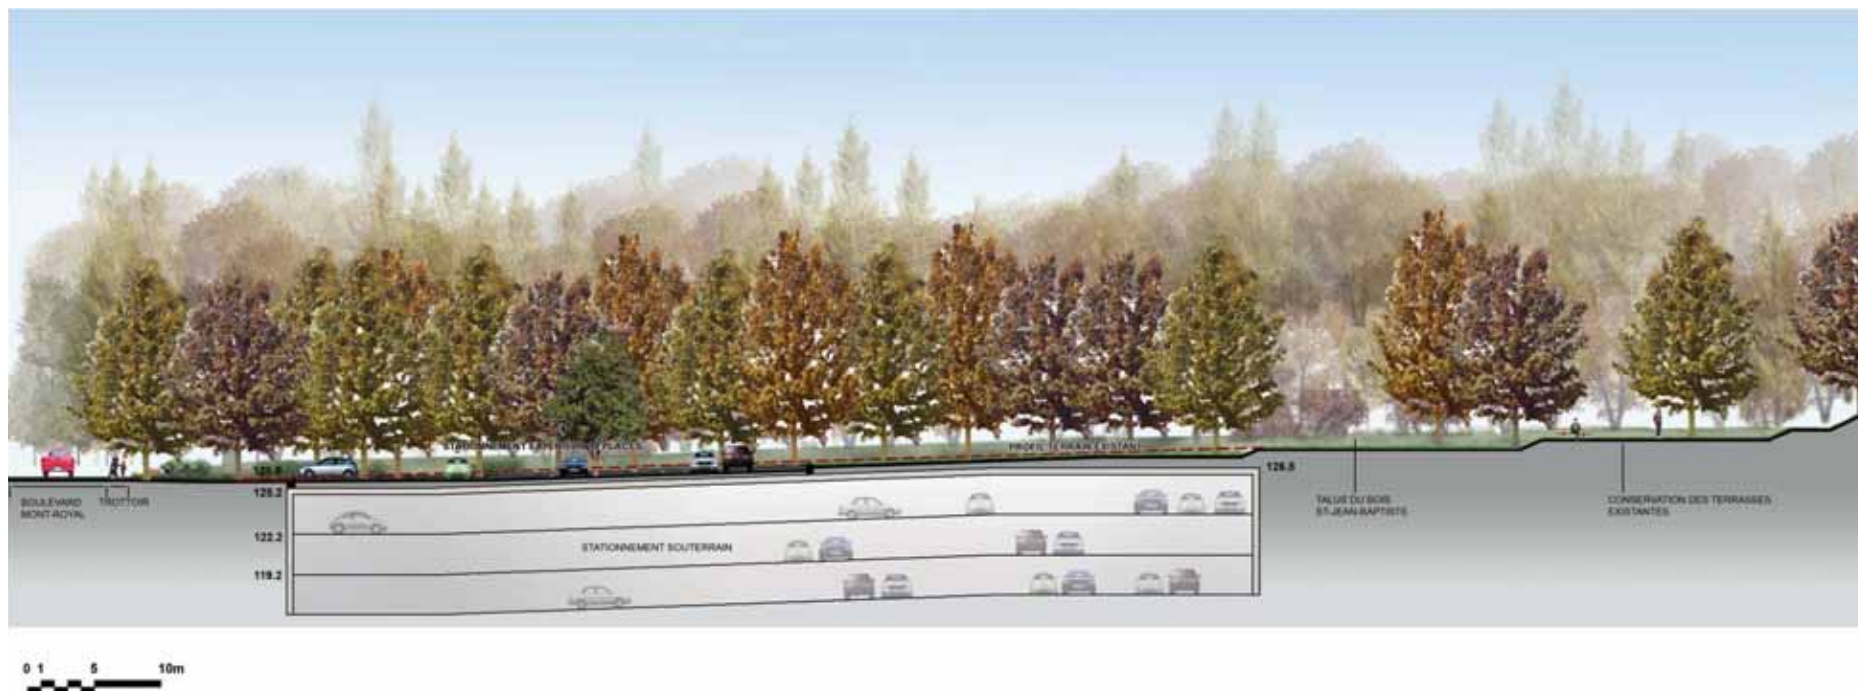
Coupe Longitudinale CC - Stationnements extérieurs, souterrains et terrasses
